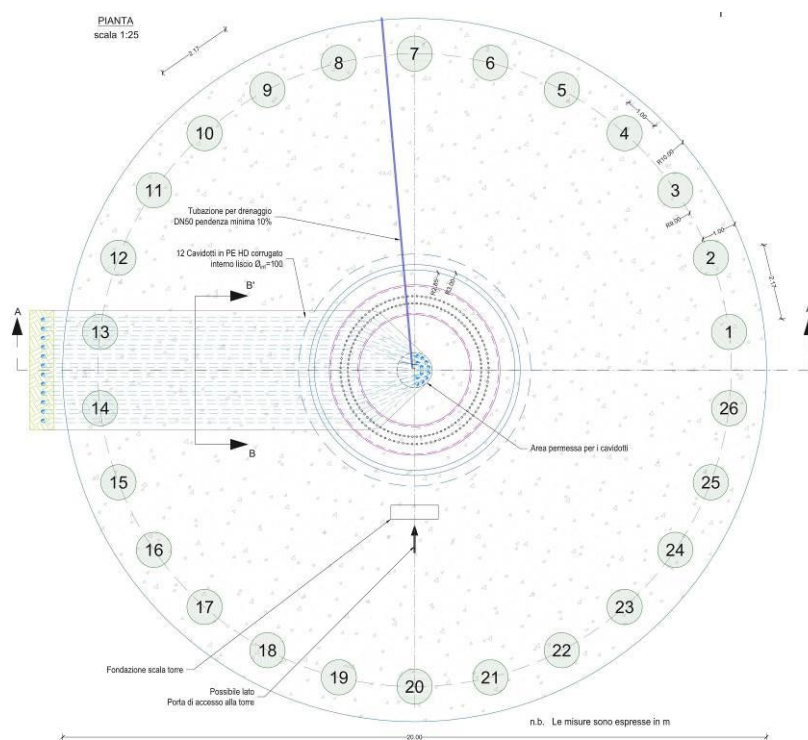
Pianta del plinto con indicazione dei pali di fondazione (n.26 del diametro 100 cm)
